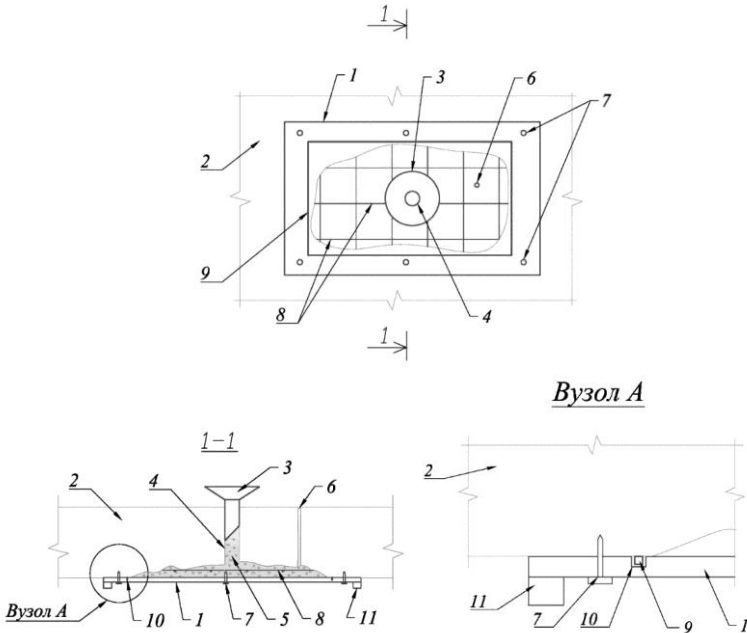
Схема монтажу опалубки та допоміжного обладнання на конструкцію, що відновлюється: 1 – опалубка; 2 – бетонна конструкція; 3 – лійка для подачі суміші; 4 – отвір для подачі ремонтної суміші Ø 50 мм; 5 – ремонтна суміш;
